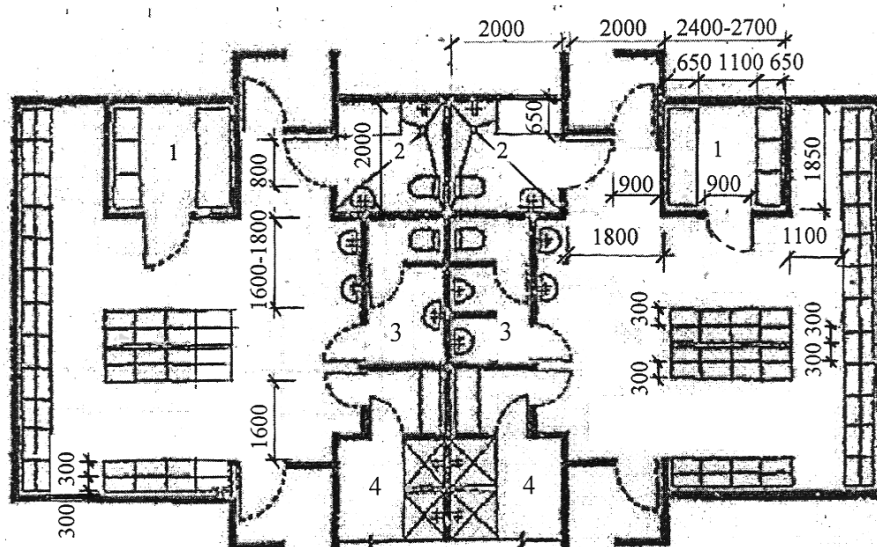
Пример планировочного решения раздевальных с отдельными местами для инвалидов: 1 – места для переодевания инвалидов; 2 – кабина для переодевания с душем и санузлом; 3 – обычный санузел; 4 – обычная душевая
